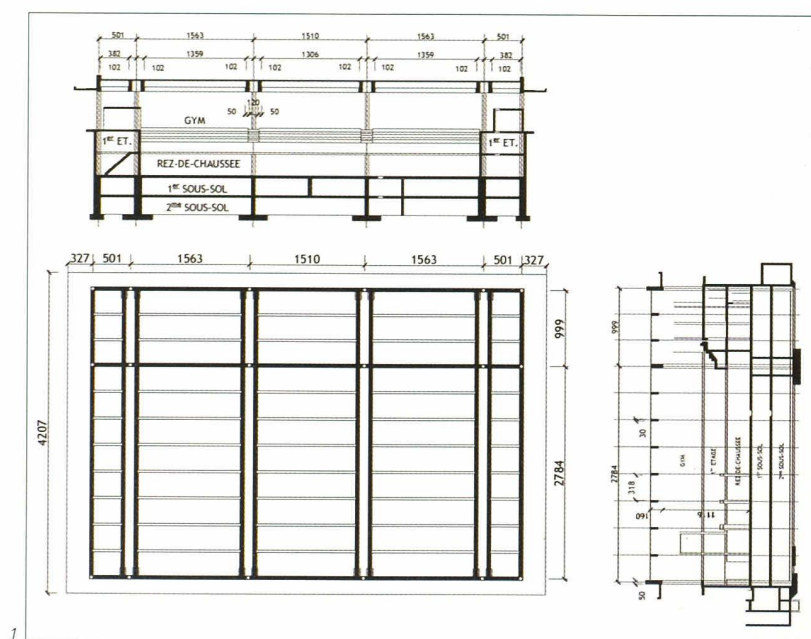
Plan, coupes longitudinale et transversale de la salle de gym
